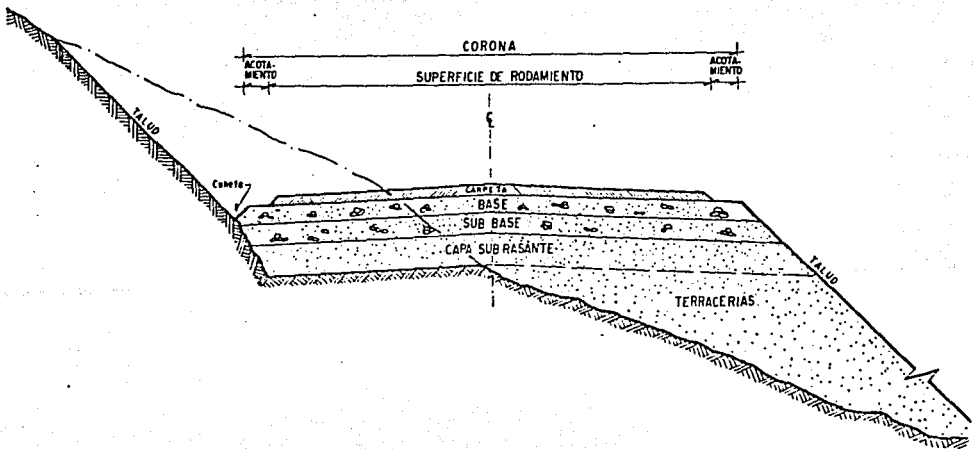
Sección transversal típica de un pavimento flexible en una sección en balcón
